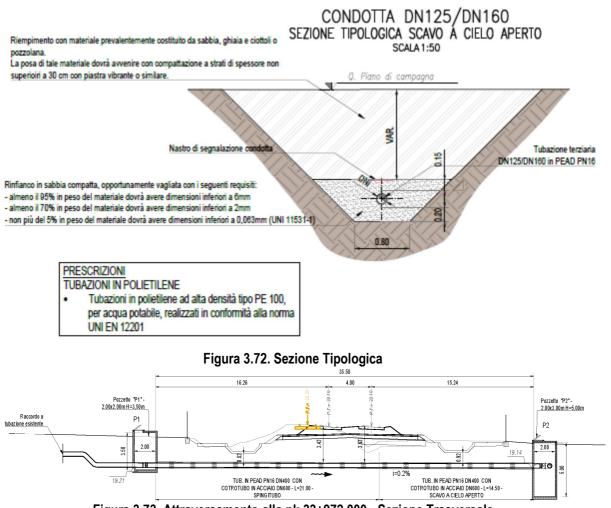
Attraversamento alla pk 33+972,000 - Sezione Trasversale
